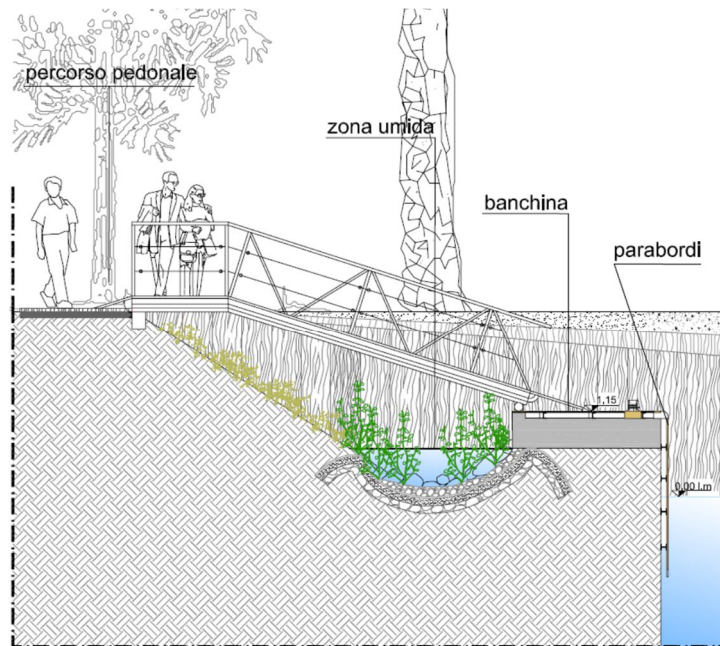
Progetto autorizzato: particolare della sponda rigida con palancole e cordolo di testa in calcestruzzo, con retrostante zona umida
